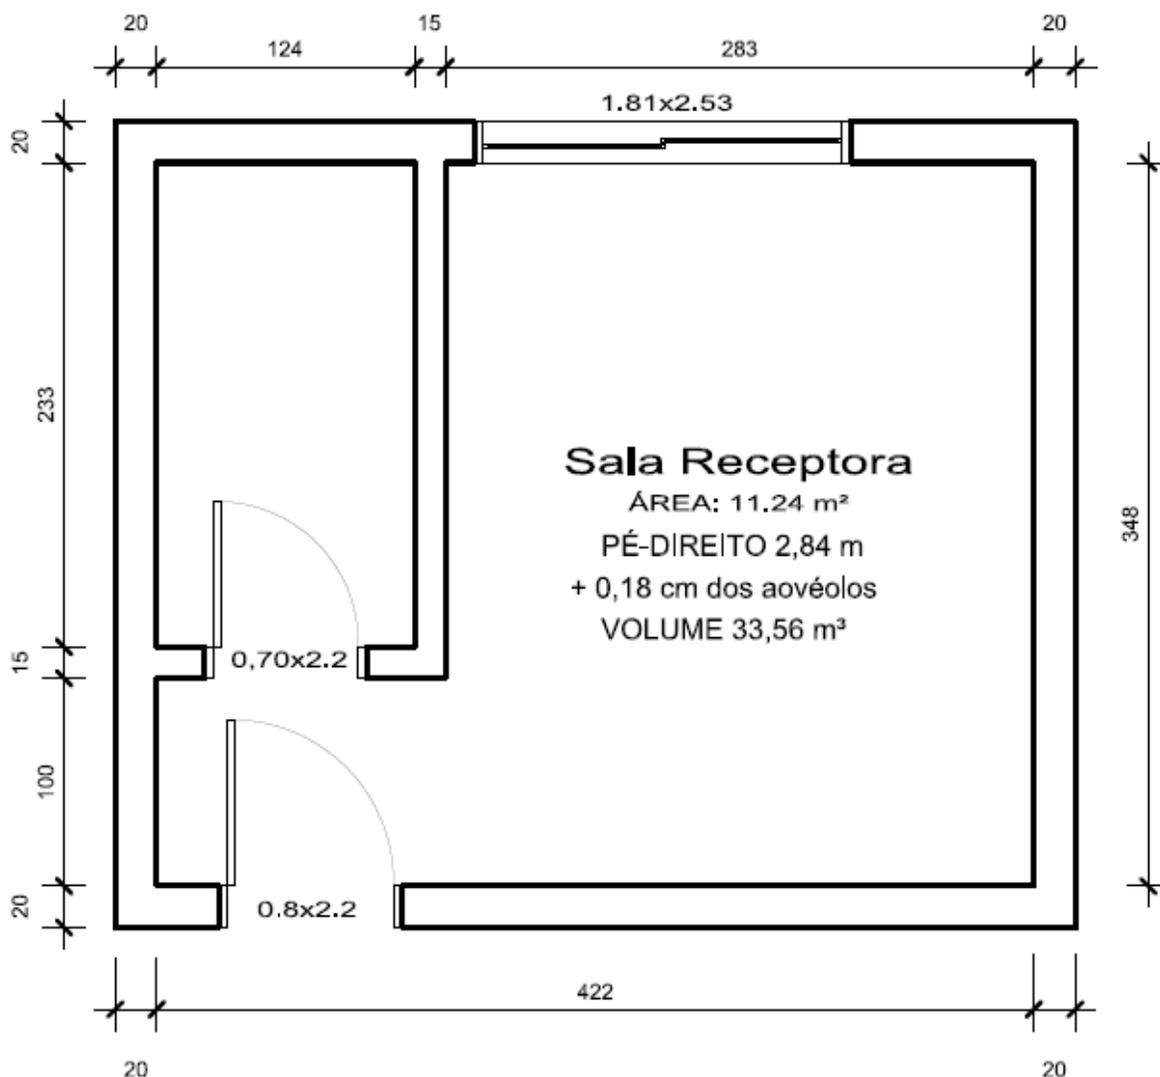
Planta baixa da sala receptora, tipologia de laje: Laje nervurada.
